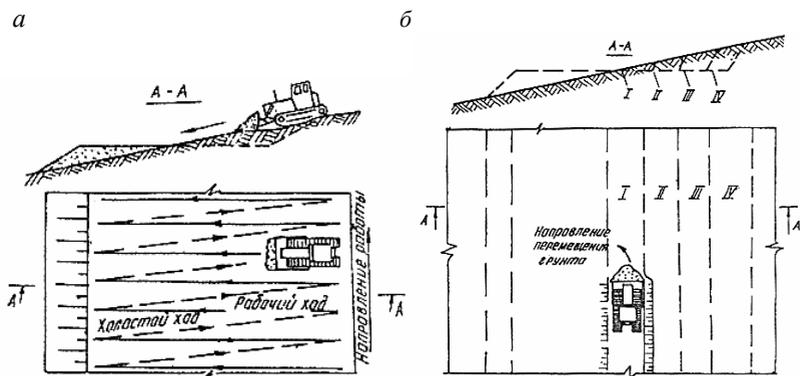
Схемы движения бульдозера при разработке полувыемки-полунасыпи на склоне поперечными (а) и продольными (б) проходками:
